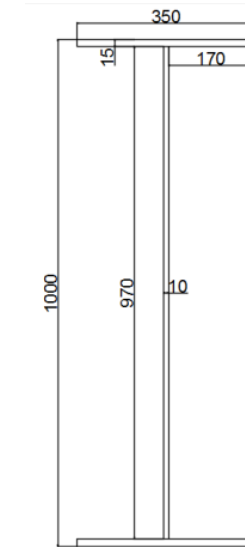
Sección de la viga de piso. Fuente: elaboración propia
